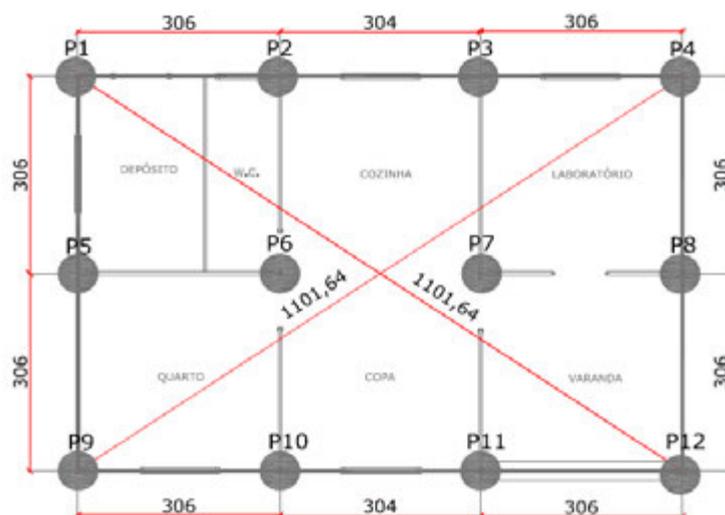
10 – Planta de locação adotada na edificação da nova ECASPSP, visando-se evitar os diversos furos para a fixação de cavaletes ou tabeiras.
